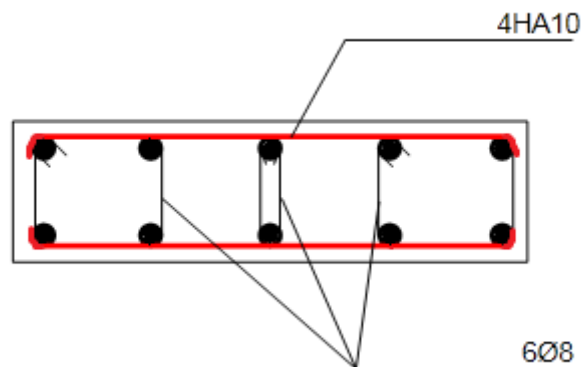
Ferrailage de section droite de la partie médiane
